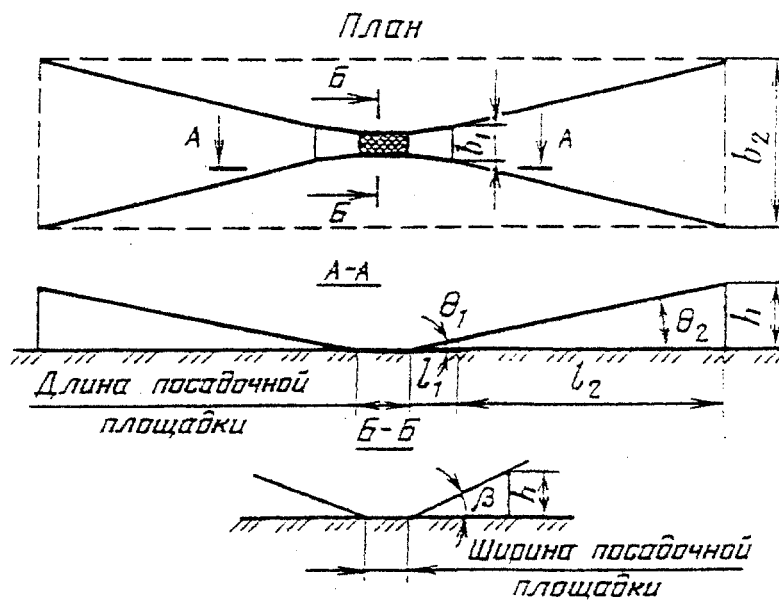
Схема посадочной площадки и зон воздушных подходов при полетах по ПВП:
